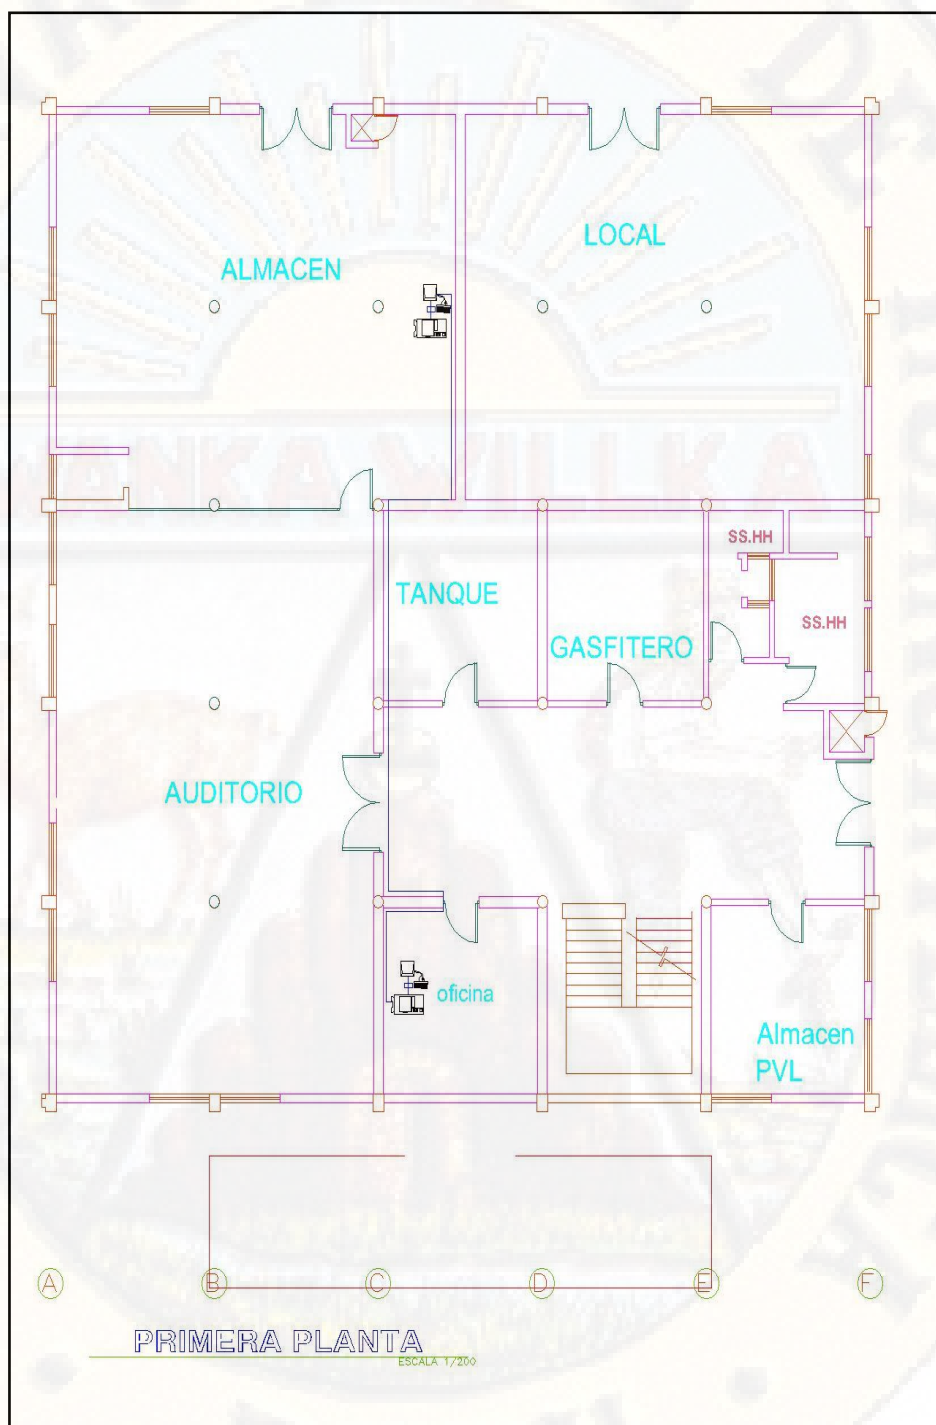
Plano de ubicación de la primera planta del edificio de la MDDH
